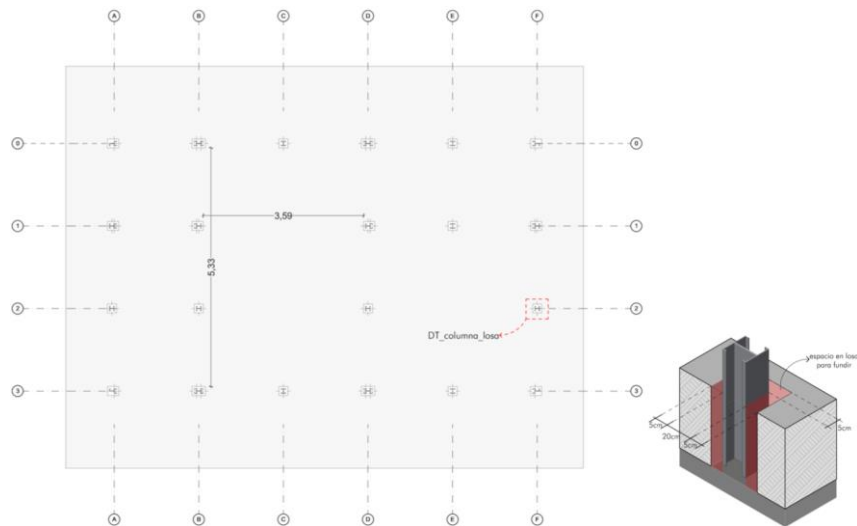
Vista en planta de la cimentación tipo losa y su detalle constructivo columna-losa
